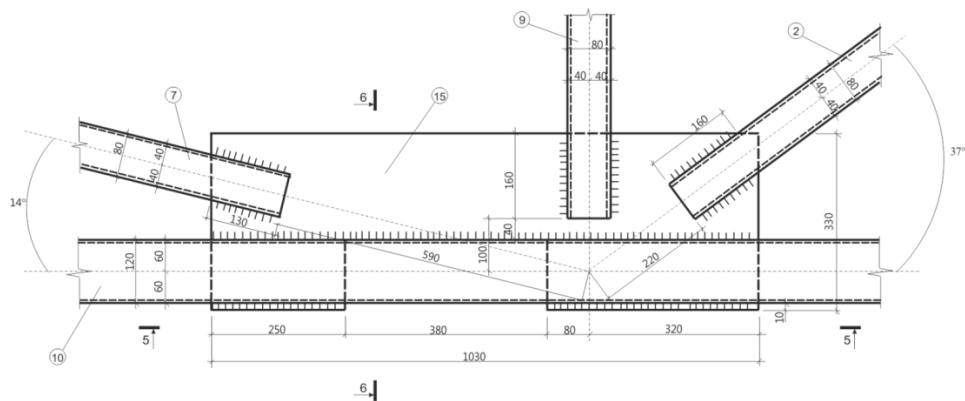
Промежуточный узел нижнего пояса фермы
